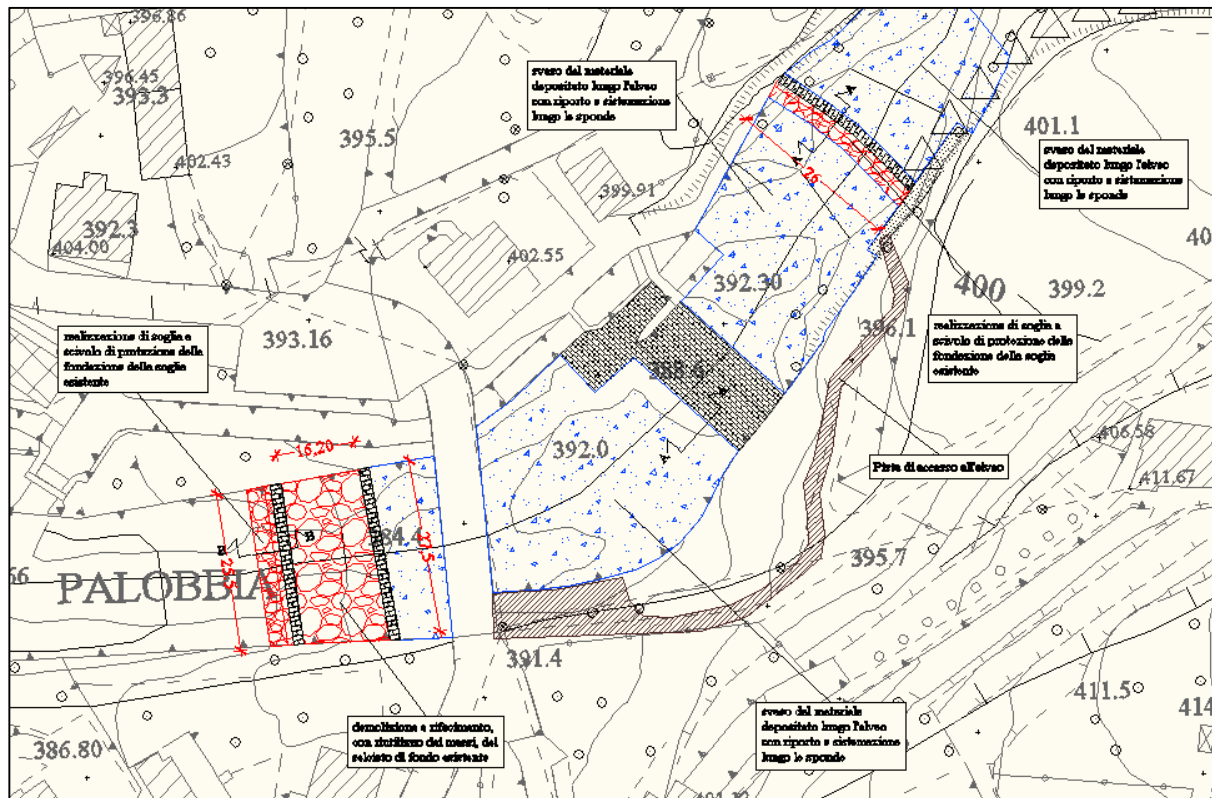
Estratto planimetria interventi in progetto area ponte di Via Palobbia
